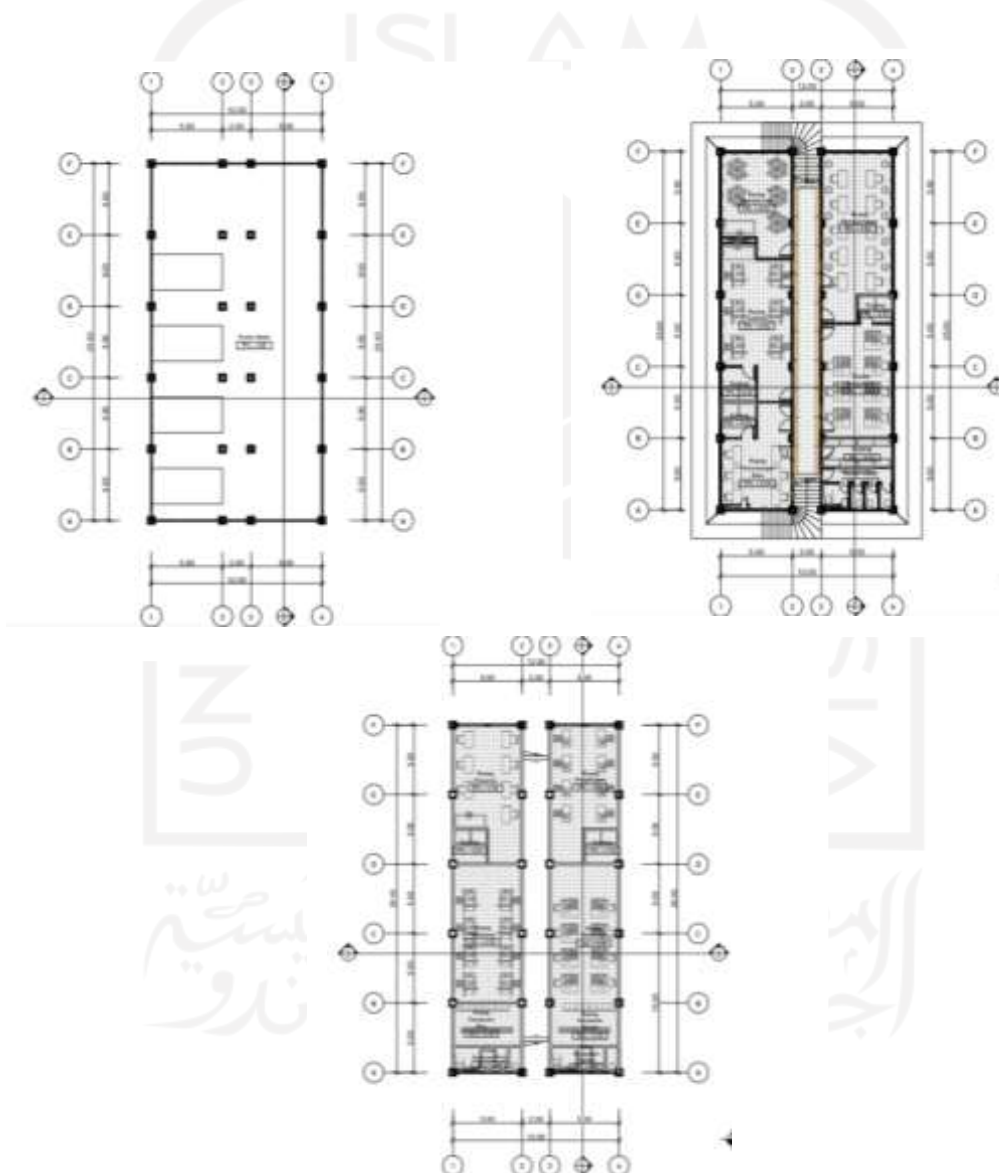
Denah Basement dan Lantai 1 Gallery
